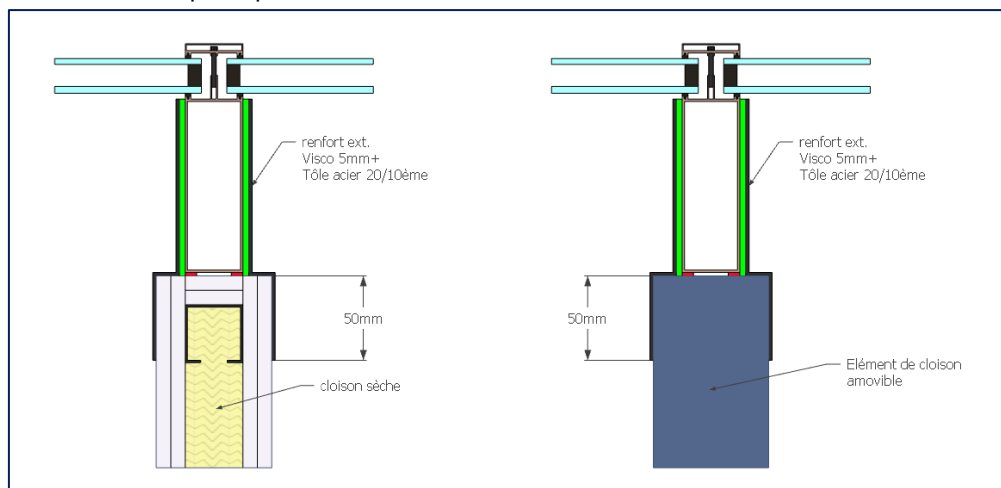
Principe de renfort des jonctions sur montant de façade (hors échelle) - flasquage
